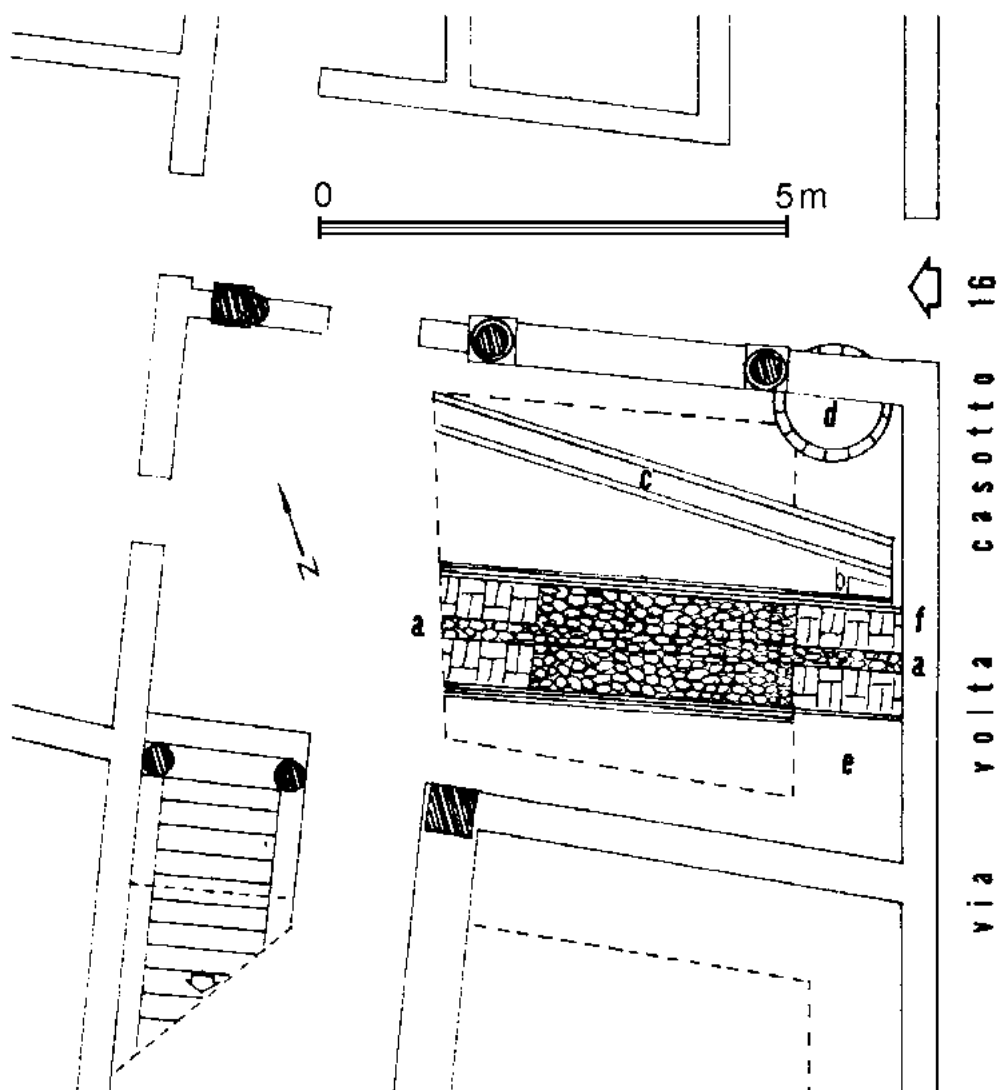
Ferrara, Casa del Capitano. Planimetria con localizzazione del muro bizantino (a-a) del saggio A della FIG. 7 (PATITUCCI 1973).
